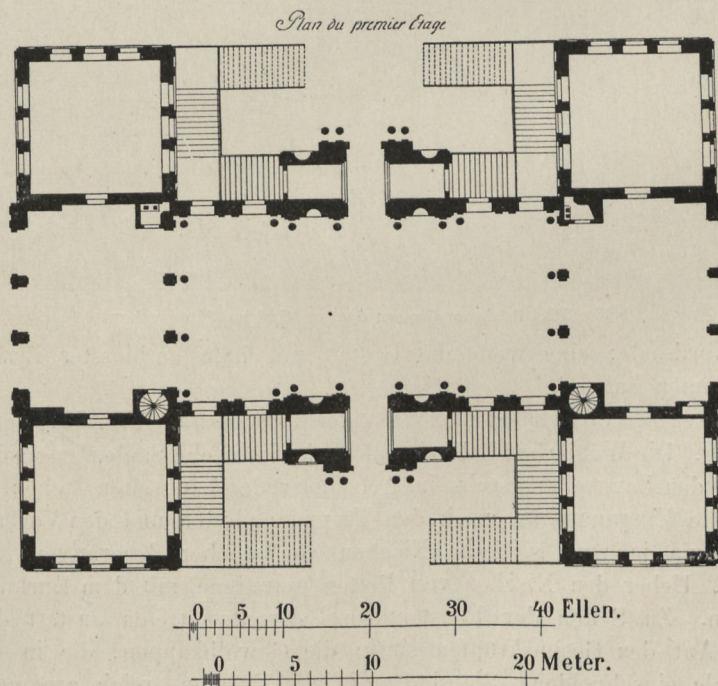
Palais im Grossen Garten. Grundriss des Obergeschosses.
